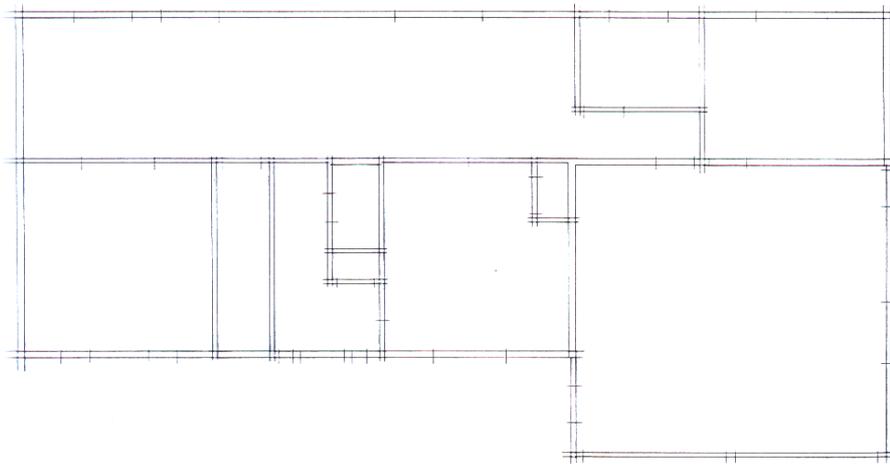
المسقط الأفقي الناتج عن مستوى القطع الأفقي المار بالمبنى
